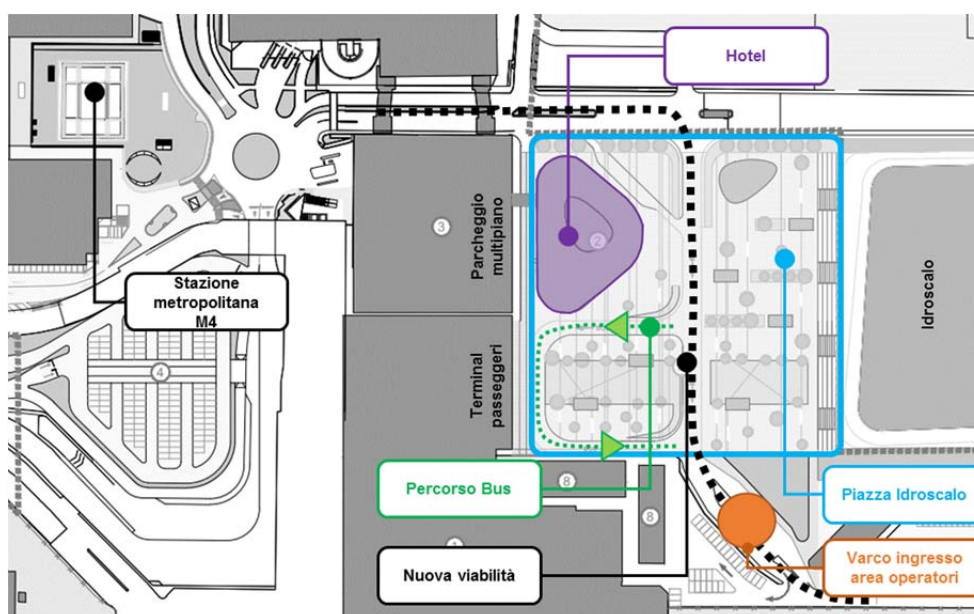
Strutture landside est: hotel e piazza idroscalo, configurazione prevista dal Masterplan
